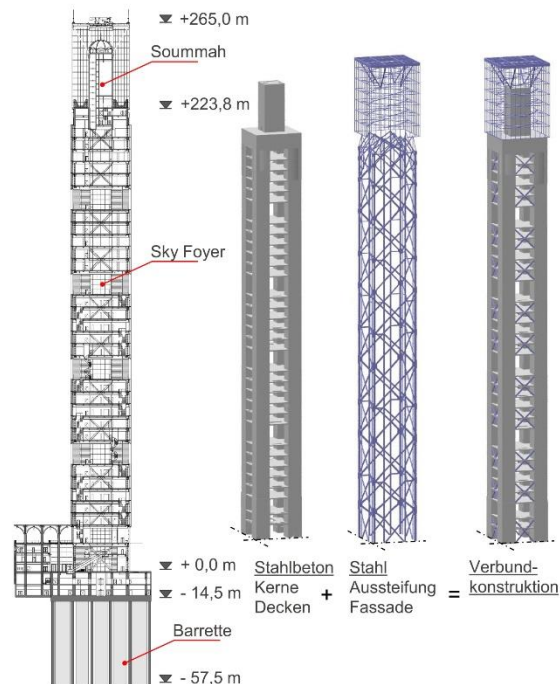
Vertikalschnitt und Tragwerk Minarett [16]
